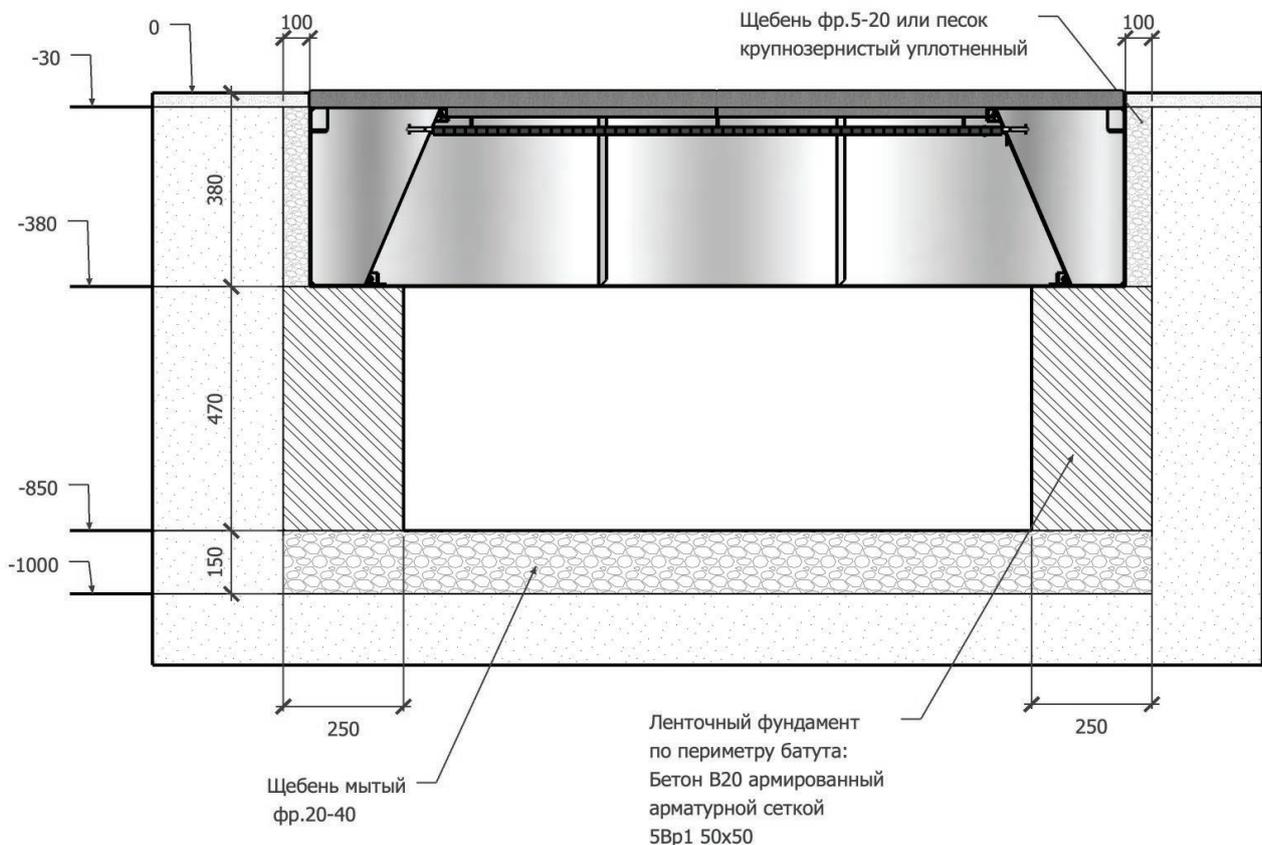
Схема монтажа для III-IV зон снеговой нагрузки или вблизи насыпных покрытий
